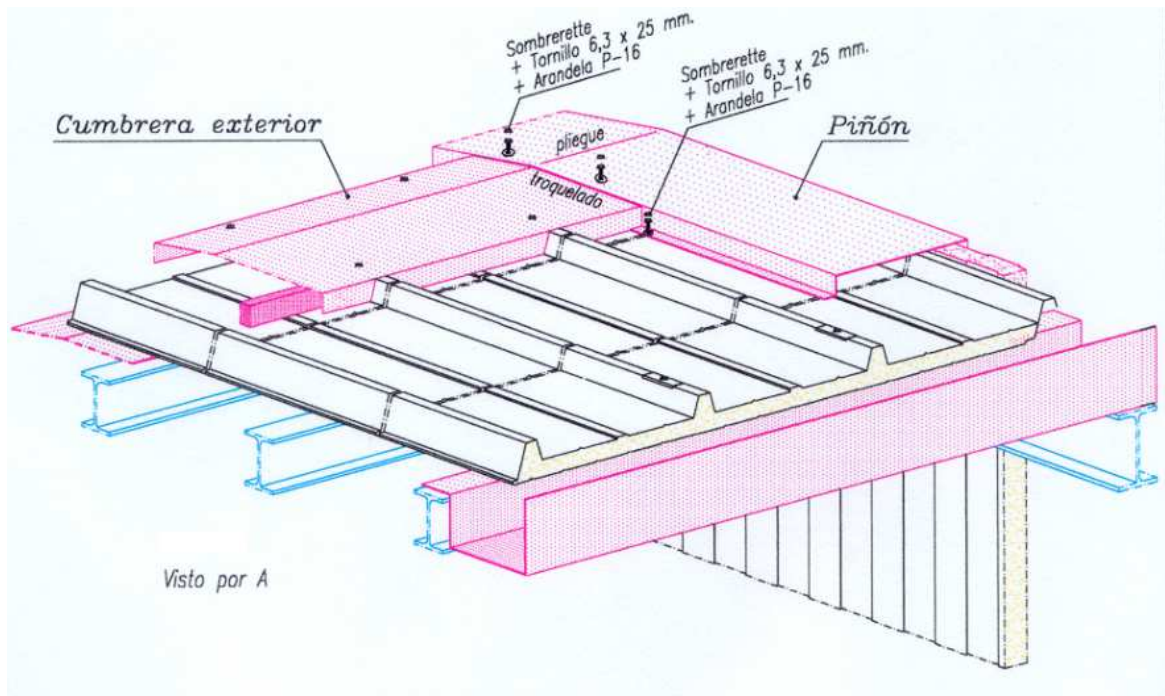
Detalle de la unión entre el panel de fachada, y los remates de piñón y de cumbrera (visto por A).
